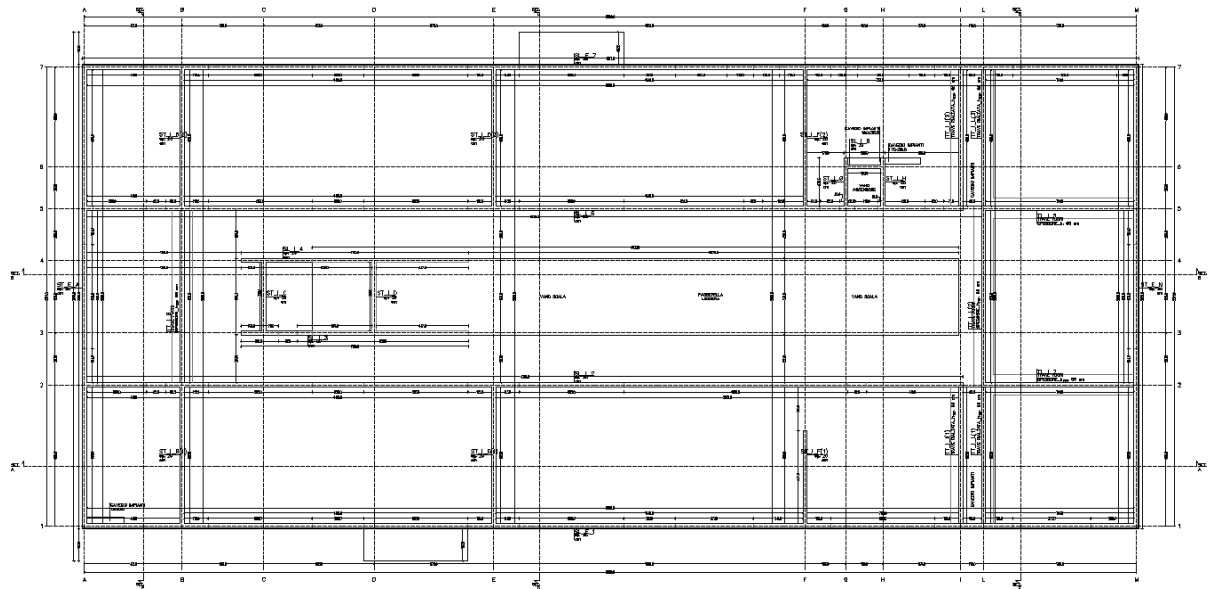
Pianta setti p.2 scuola: strutture in progetto
